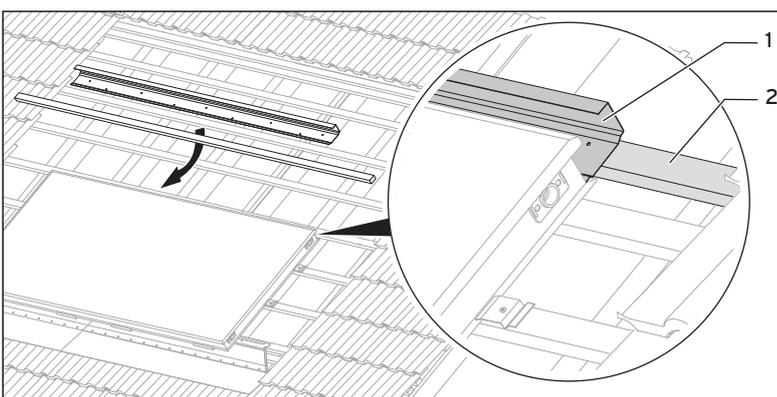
Abstandhalter und Dachlatte positionieren
